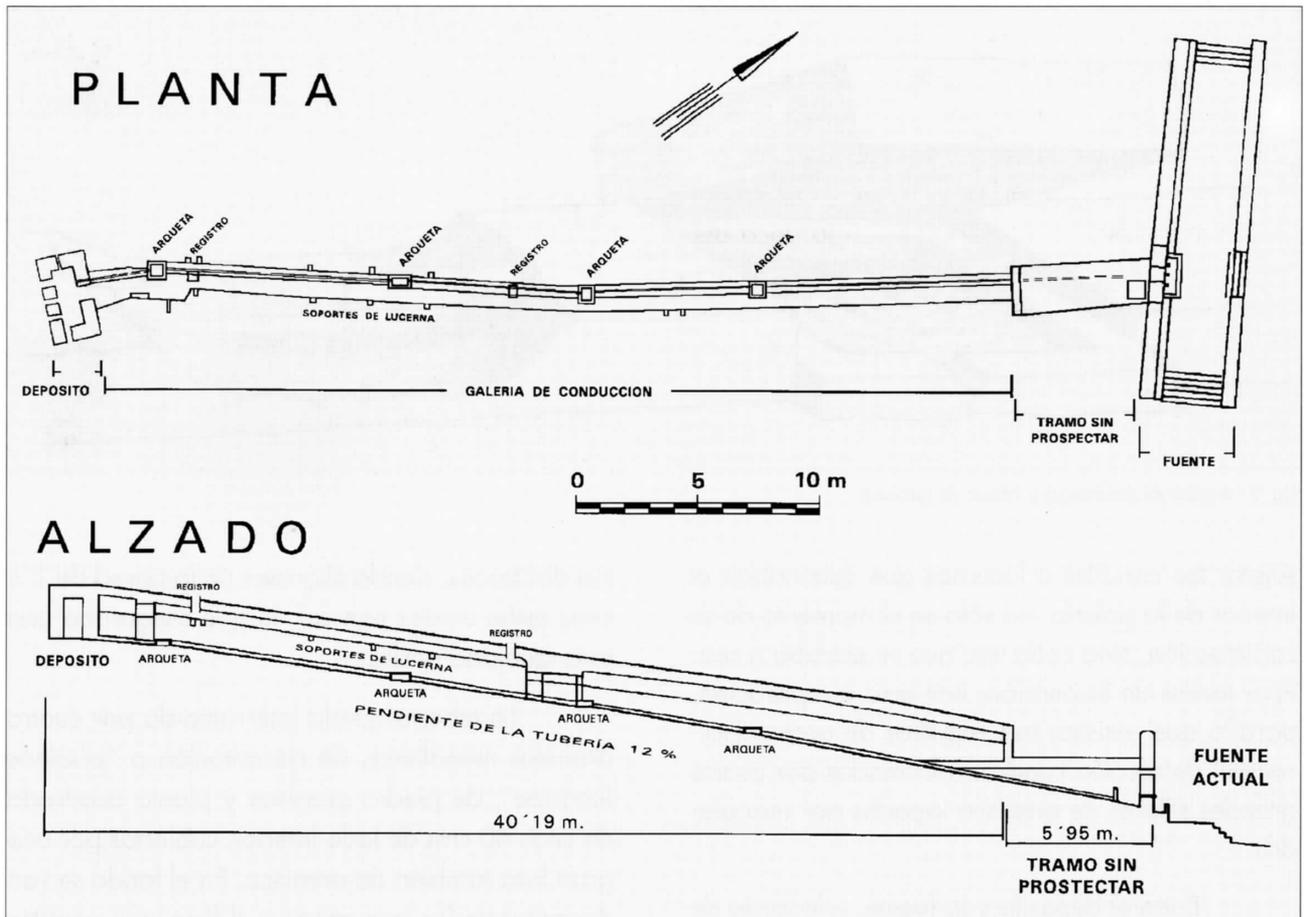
Planta y alzado del conjunto hidráulico de "La Canal".
